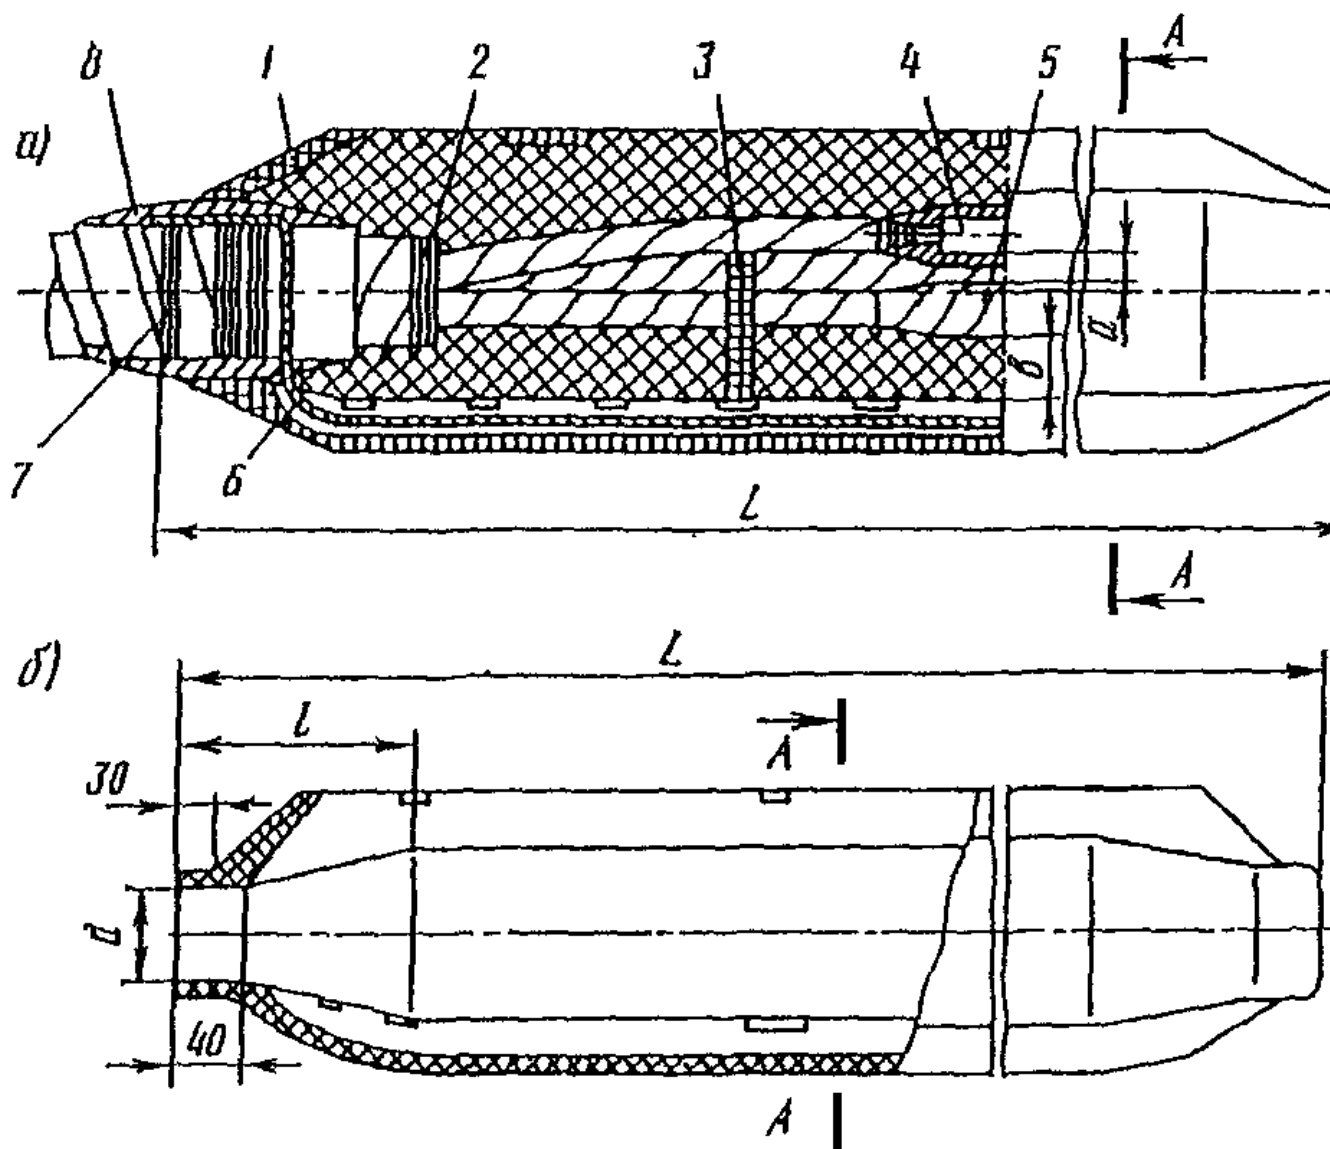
Соединение кабелей в эпоксидной муфте типа СЭв: а - муфта; б - корпус; 1 - корпус муфты; 2 - бандаж по изоляции из суровых ниток; 3 - распорка; 4 - соединение жил; 5 - подмотка жил; 6 - провод заземления; 7 - проволочный бандаж для крепления провода заземления; 8 - герметизирующая подмотка в два слоя; 9 - скоба для крепления обеих половин корпуса муфты
